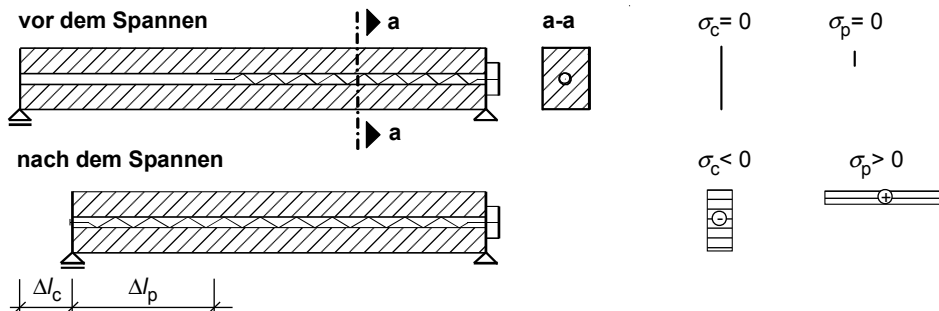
Prinzip des Spannbetons (prestressed concrete)
